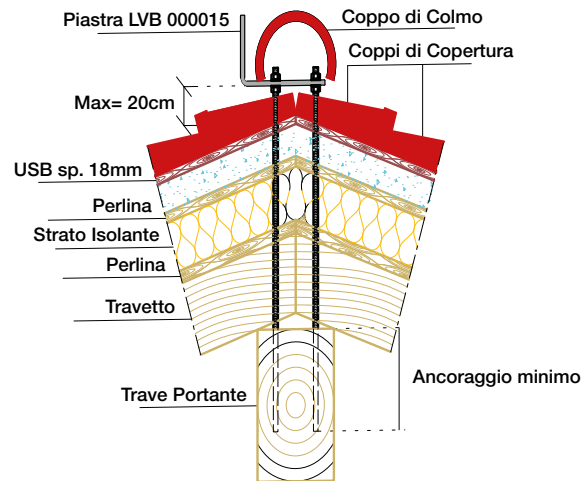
Sezione del dispositivo LVB fissato su struttura di supporto in legno.
